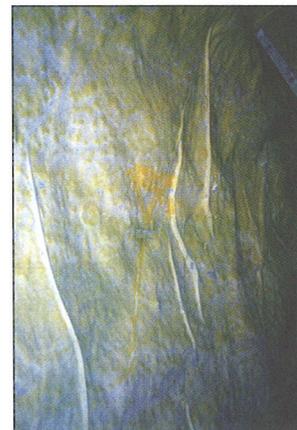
Vertikal verlaufende bis 5 cm in den Beton ragende Falten in einer PVC-P-Dichtungsbahn
